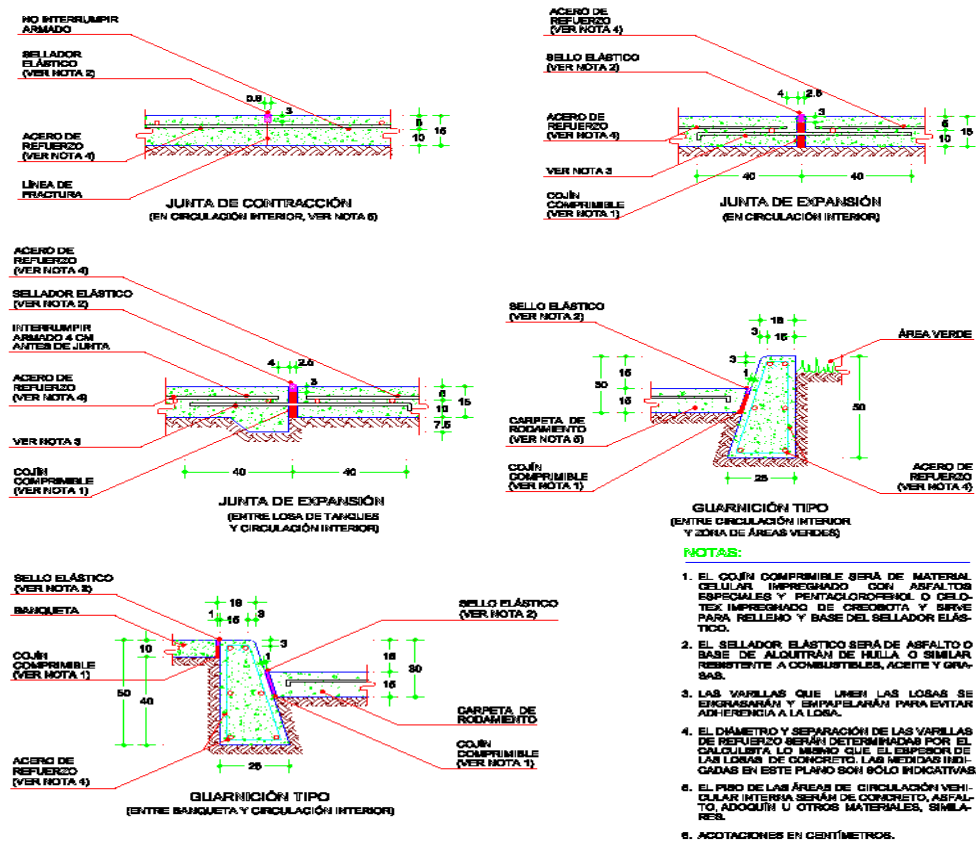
Juntas de contracción y expansión en zona de tanques y circulación terrestre.
